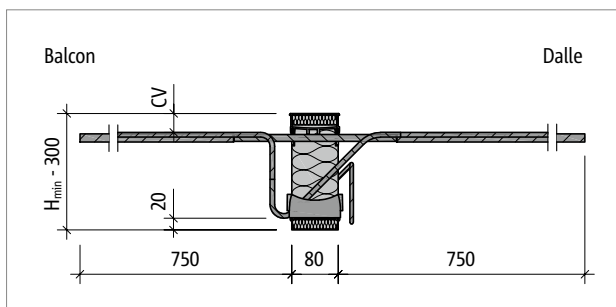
Schöck Isokorb® T Type K-E-M8 : Coupe du produit
